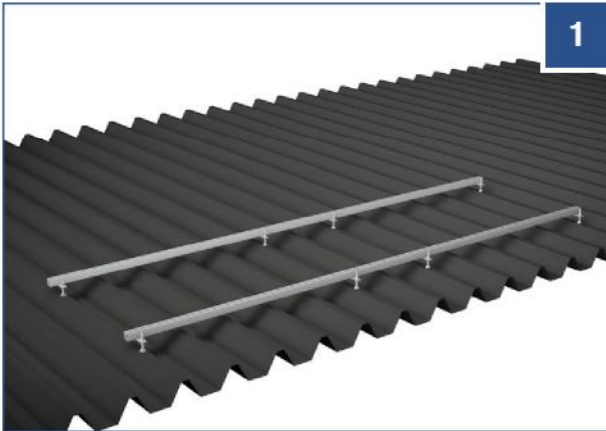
Se pueden utilizar diversas piezas de unión para conectar en línea varias vigas de sistema:
